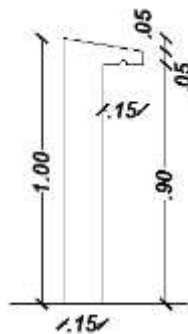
Acrotère type 1 (Terrasse accessible)
